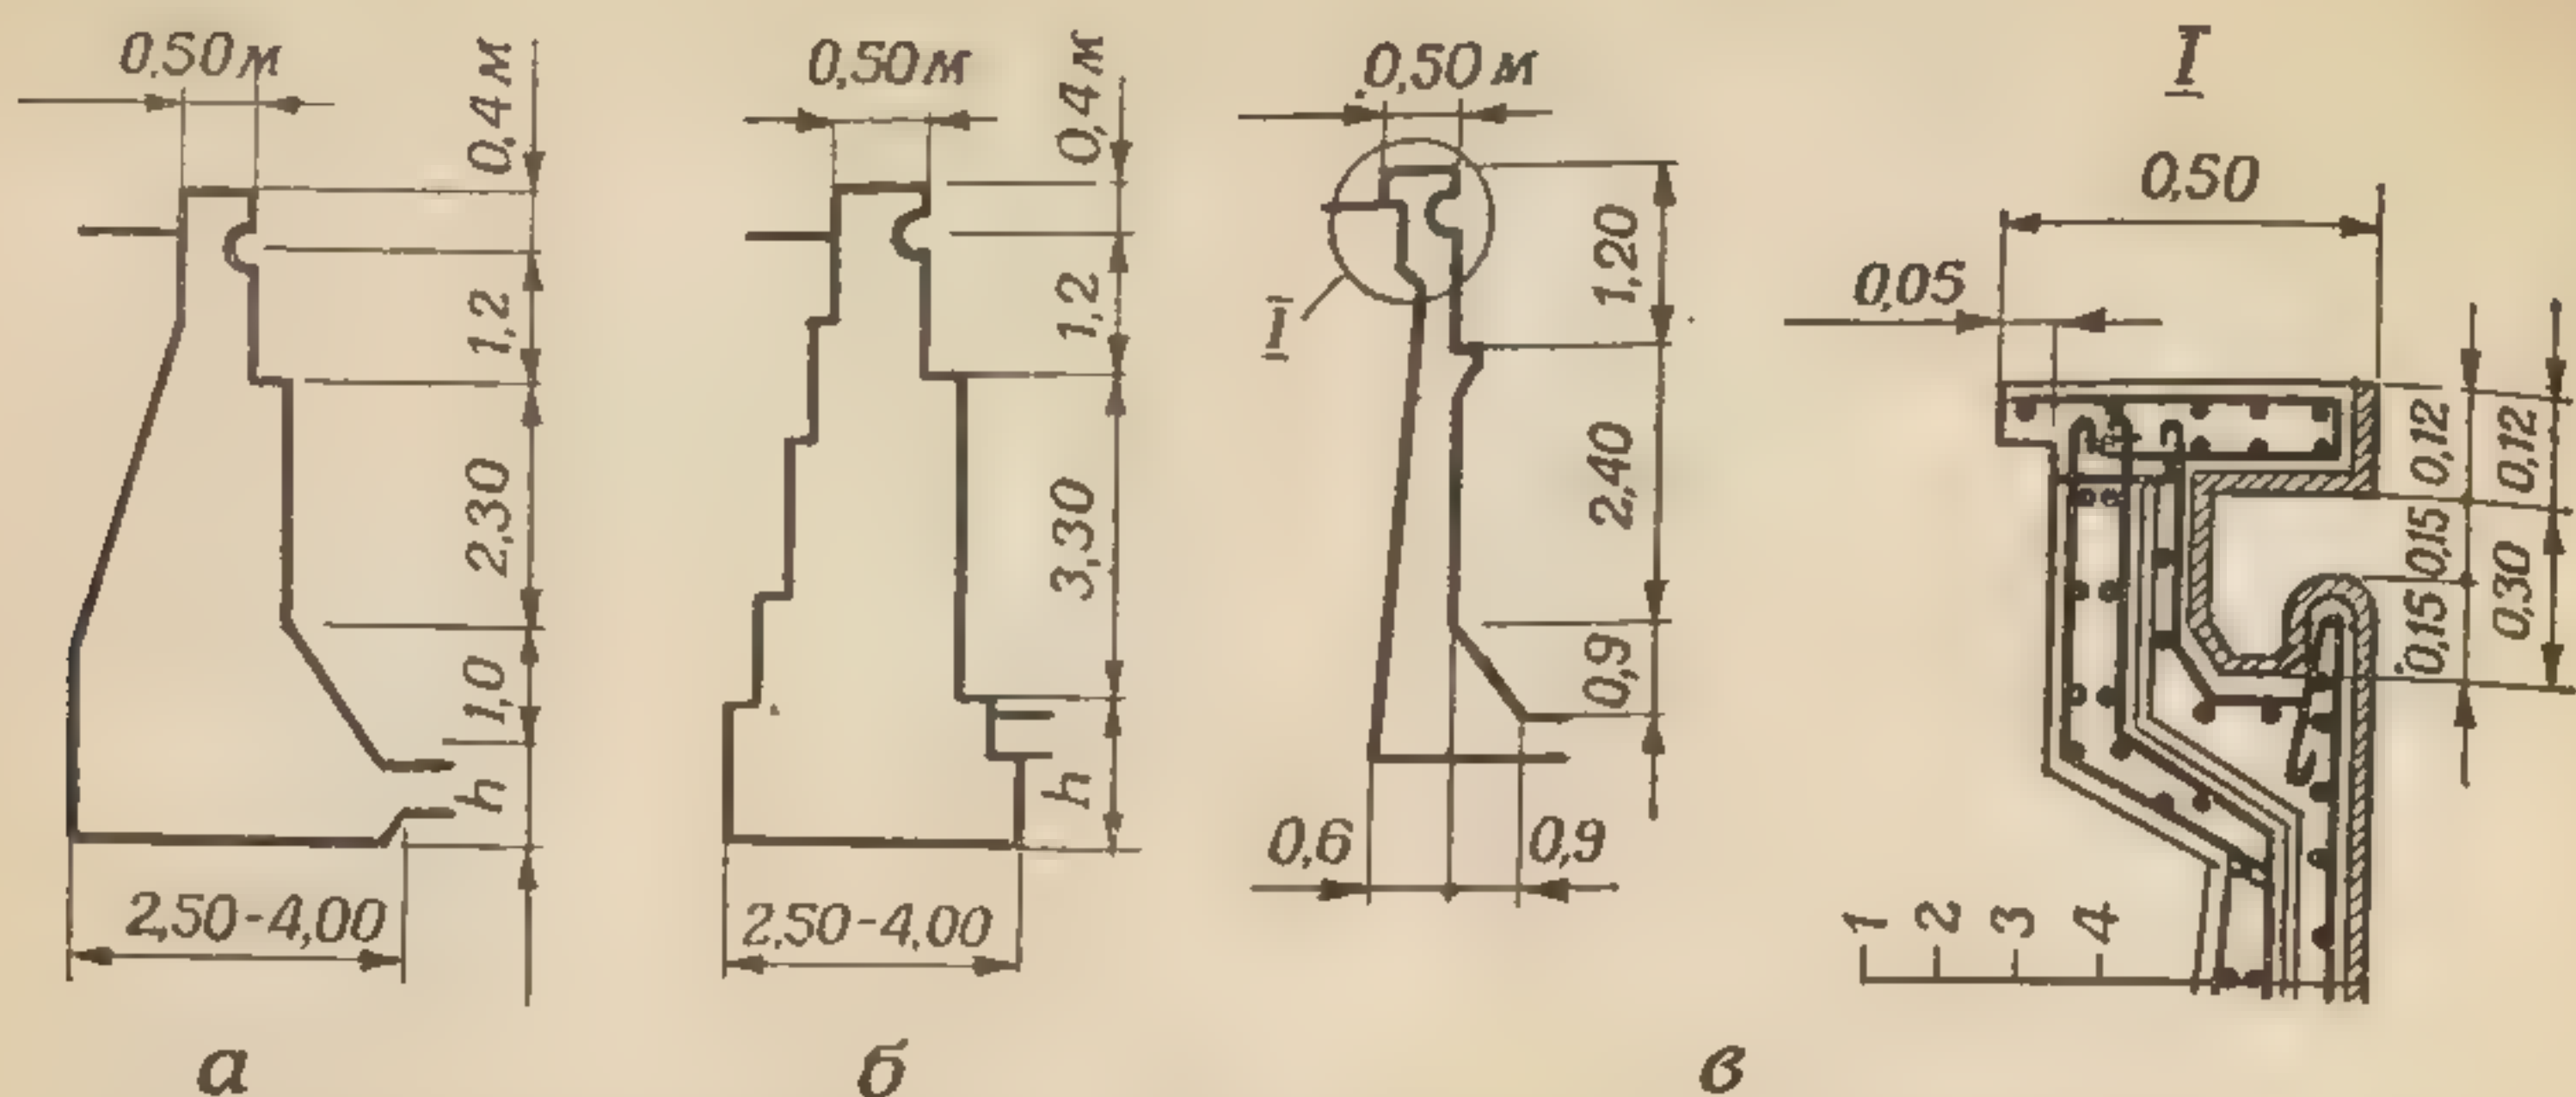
Профиль вертикальных стенок ванн бассейнов из различных материалов: а — из бетона; б — из каменной кладки; в — из железобетона; I — деталь переливного желоба: 1 — корпус ванны; 2 — гидроизоляция; 3 — цементная стяжка; 4 — облицовка
